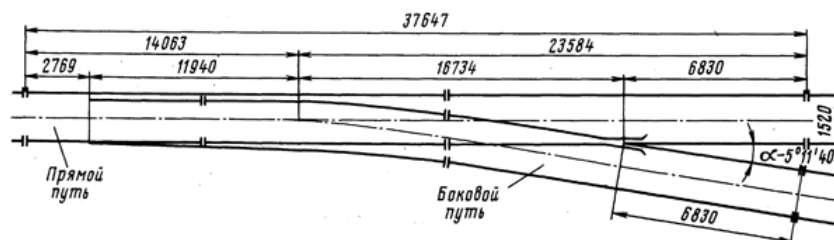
Обыкновенный одиночный стрелочный перевод типа Р65 марки 1/11
